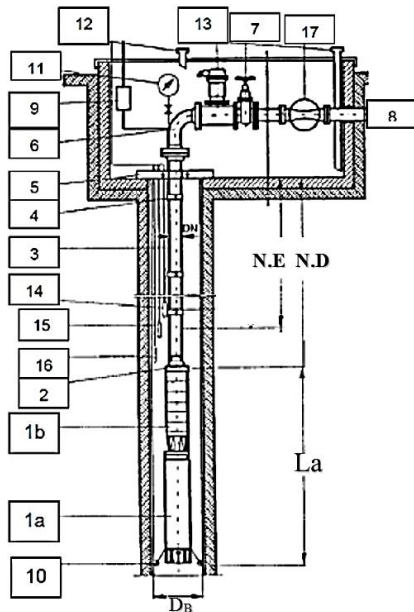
Instalación de la bomba sumergible de pozo profundo. Fuente: plano de instalación de la planta.
